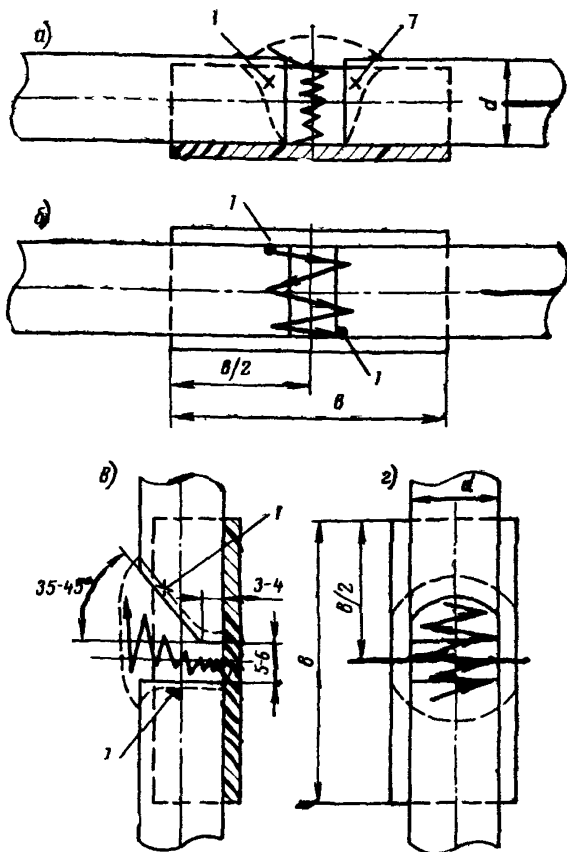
Рекомендуемые условия сборки со скобами-подкладками и техника сварки стыковых соединений стержней
